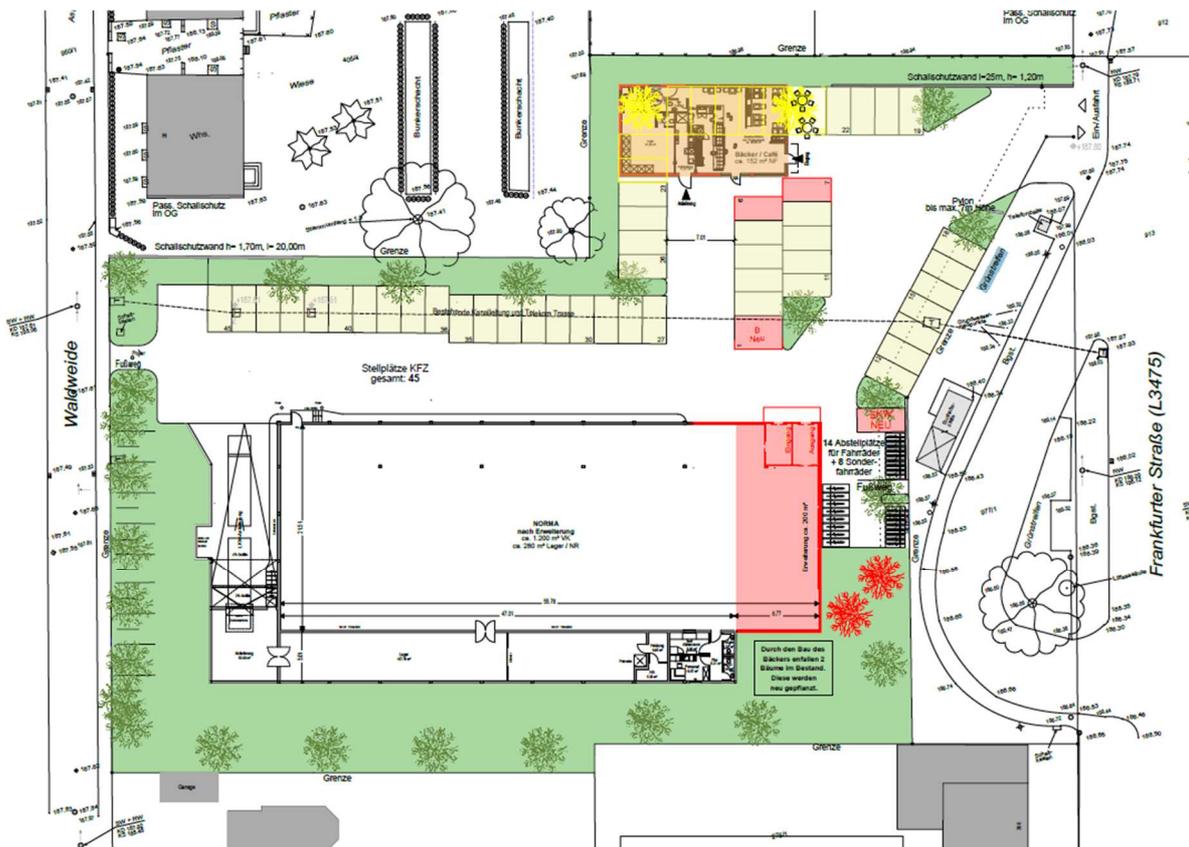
Lageplan mit geplanter Markterweiterung und Bäckerei-Shop (Norma, 27.02.2024)
